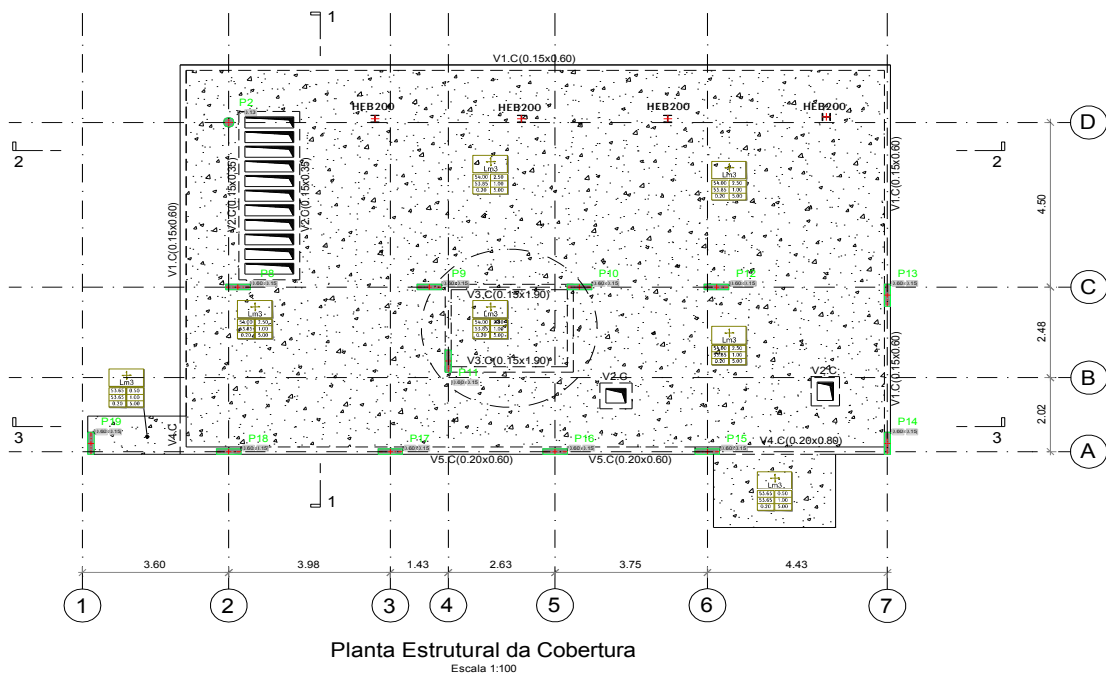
PLANTA ESTRUTURAL DA COBERTURA (AUTOCAD)
